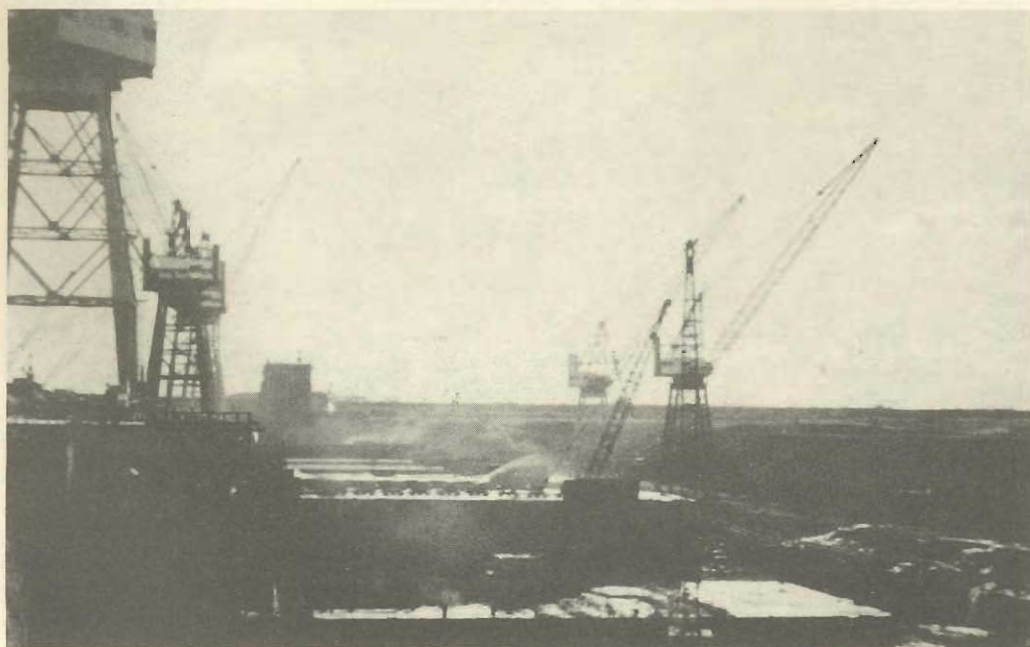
Guindaste tipo portuário utilizado para lançamento do concreto - Ilha Solteira
